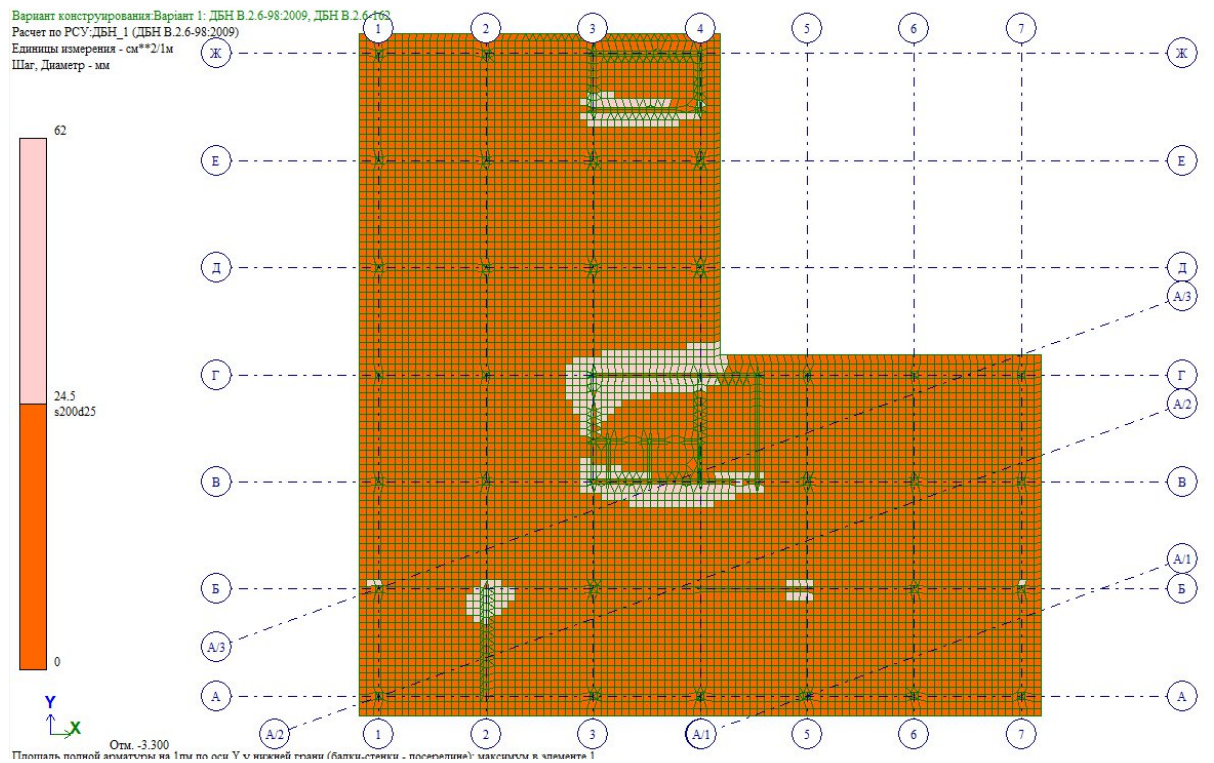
Площа арматури на 1пм біля нижньої грані по осі У
